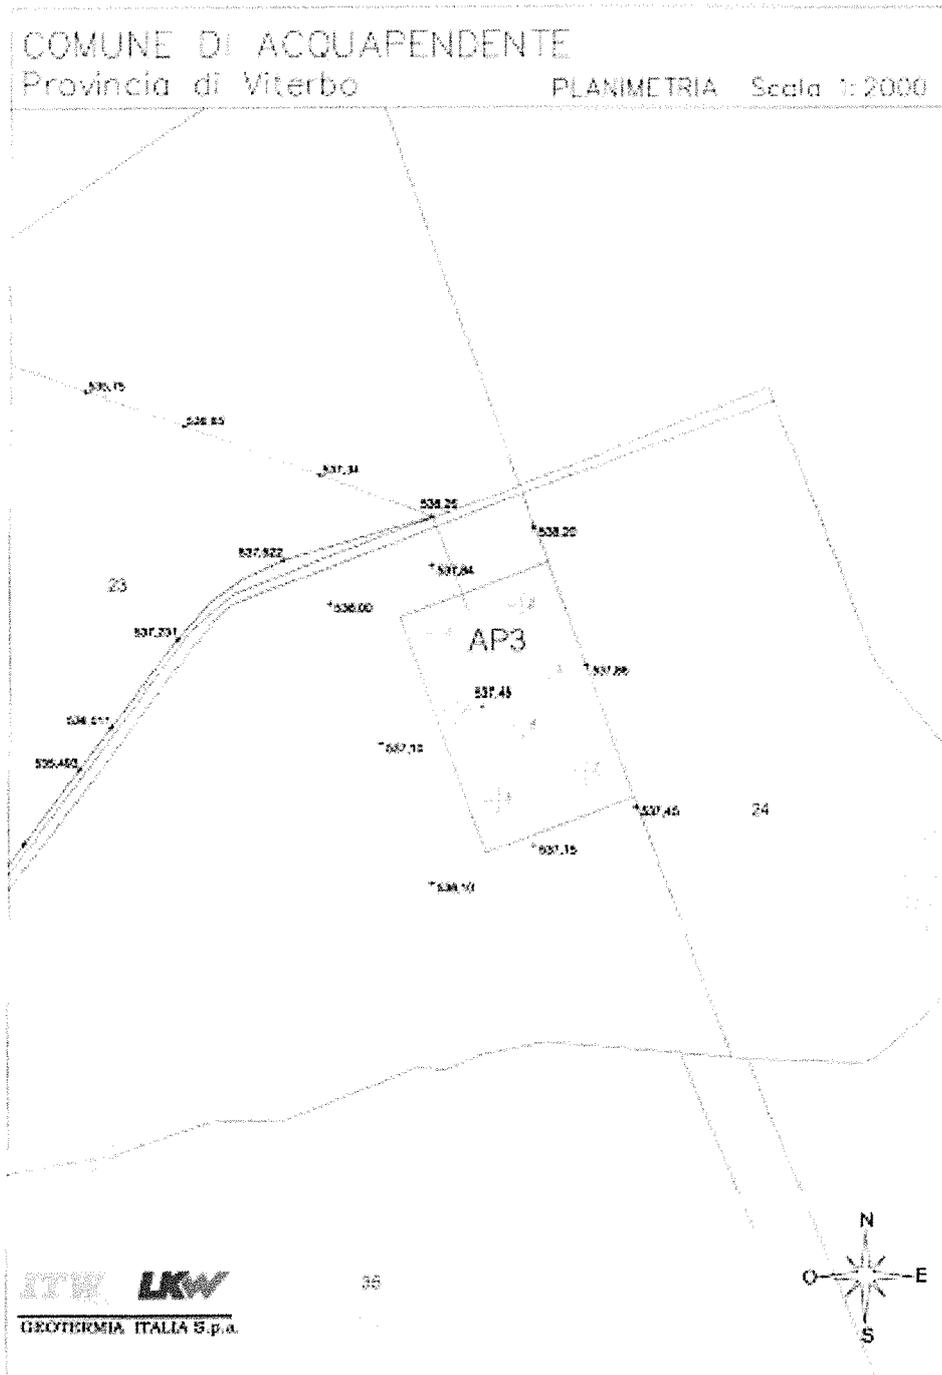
Planimetria della postazione AP3 con l'indicazione dei punti di sondaggio
